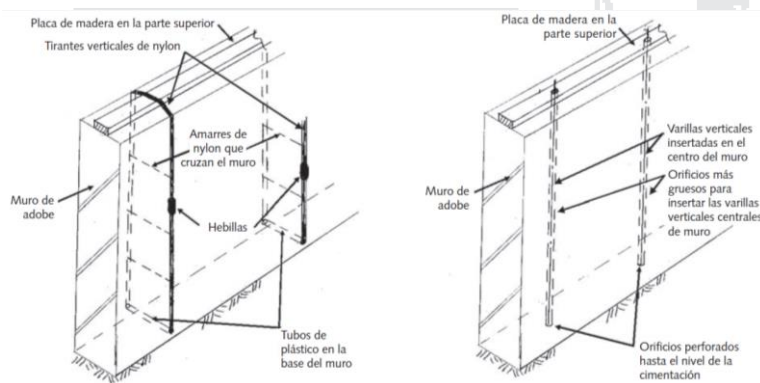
Izquierda: Refuerzo con tirantes y amarres que atraviesan un muro de adobe. Derecha: Refuerzo con varillas verticales insertadas en el centro de un muro de adobe (Esquivel, 2009).
